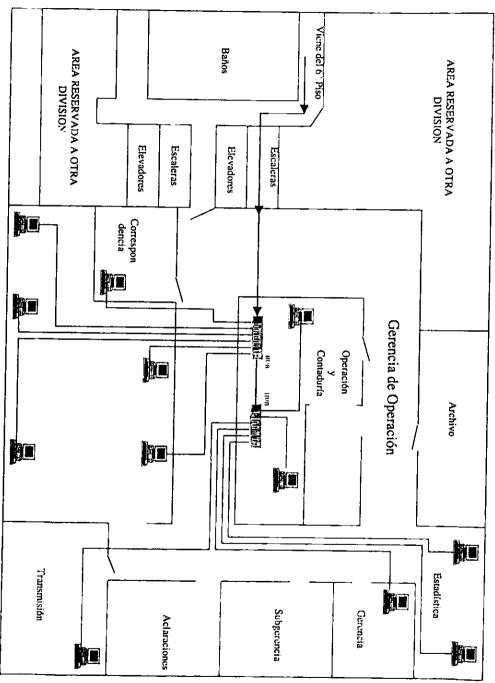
Plano de Cableado del 5º Piso del Equipo Informático Actual
